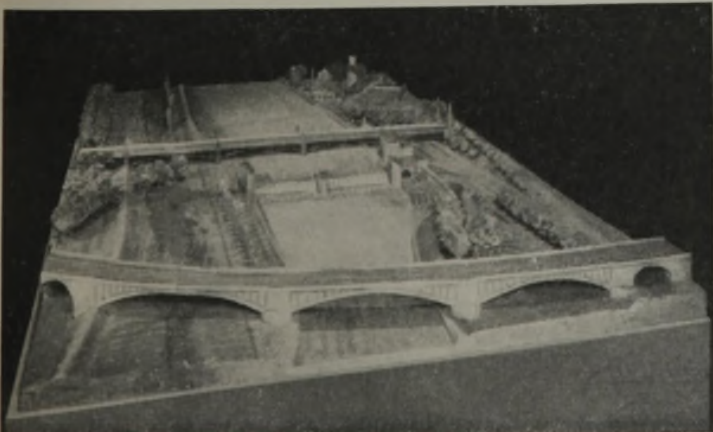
Staustufe Cannstatt. Modell von Wehr und Kraftwerk.
